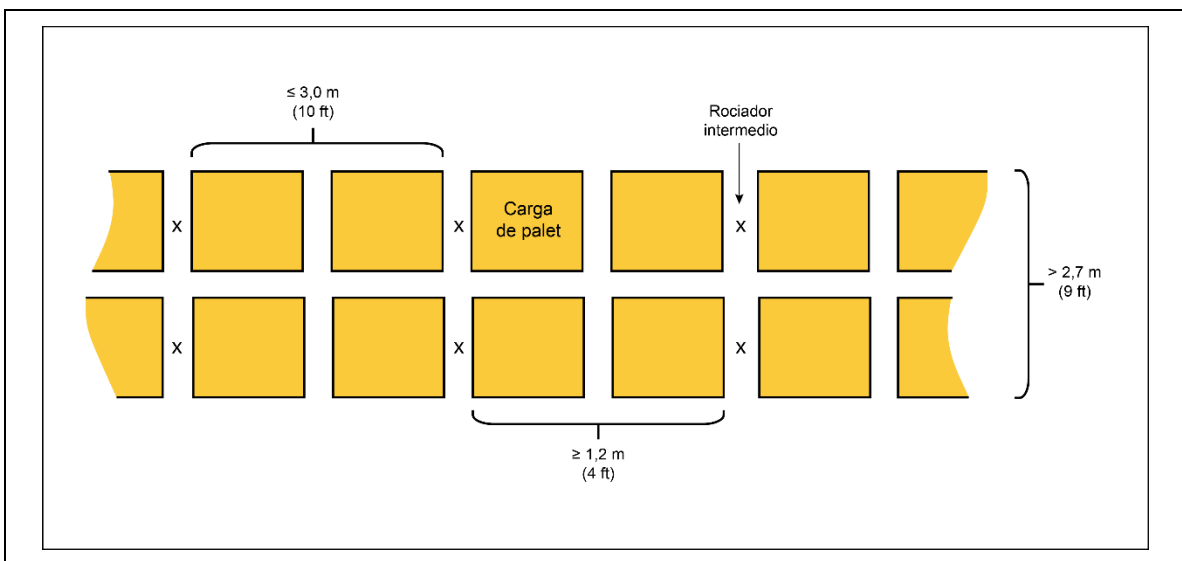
Vista en planta de una configuración horizontal de rociadores intermedios cada dos chimeneas transversales para estanterías dobles cuya profundidad sea superior a 2,7 m (9 ft)
